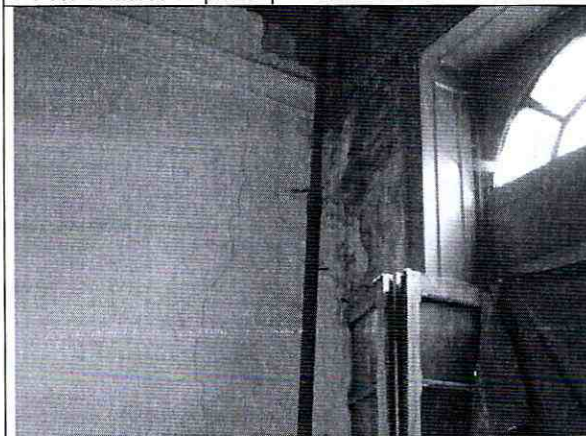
Agrietamiento vertical en muro de segundo piso.
